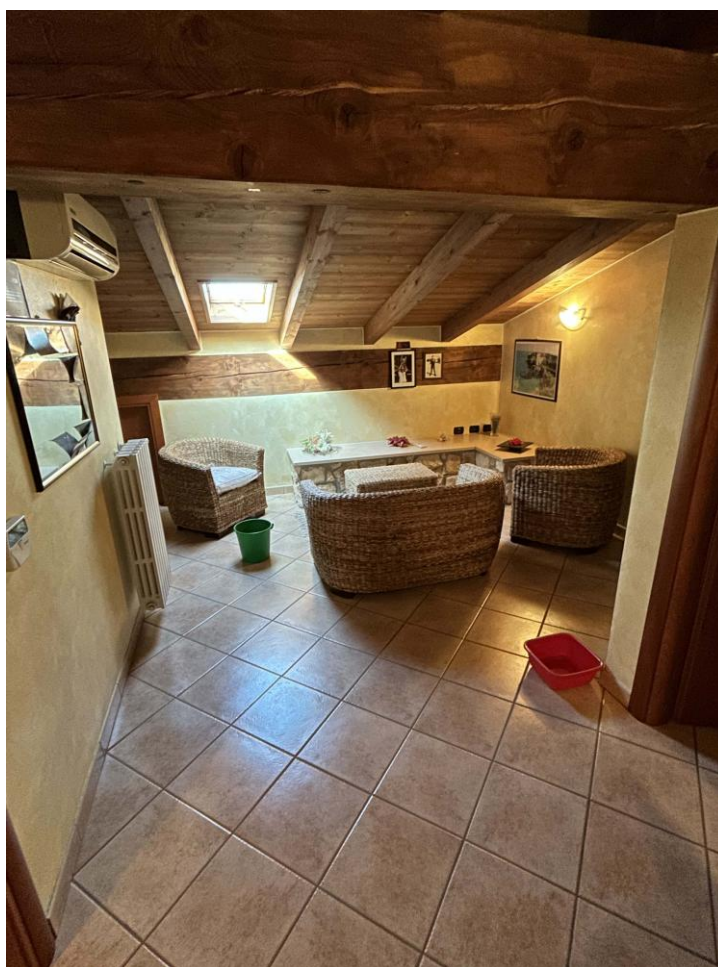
Appartamento – Sottotetto – Locale n. 1
